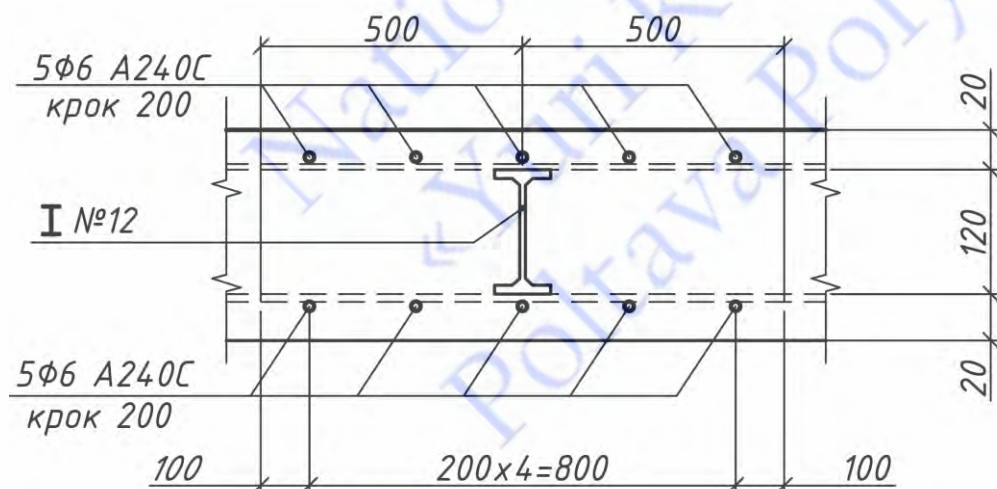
Загальний вигляд армування 1 п.м перерізу плитного елемента сталезалізобетонного міжповерхового перекриття будівлі.
